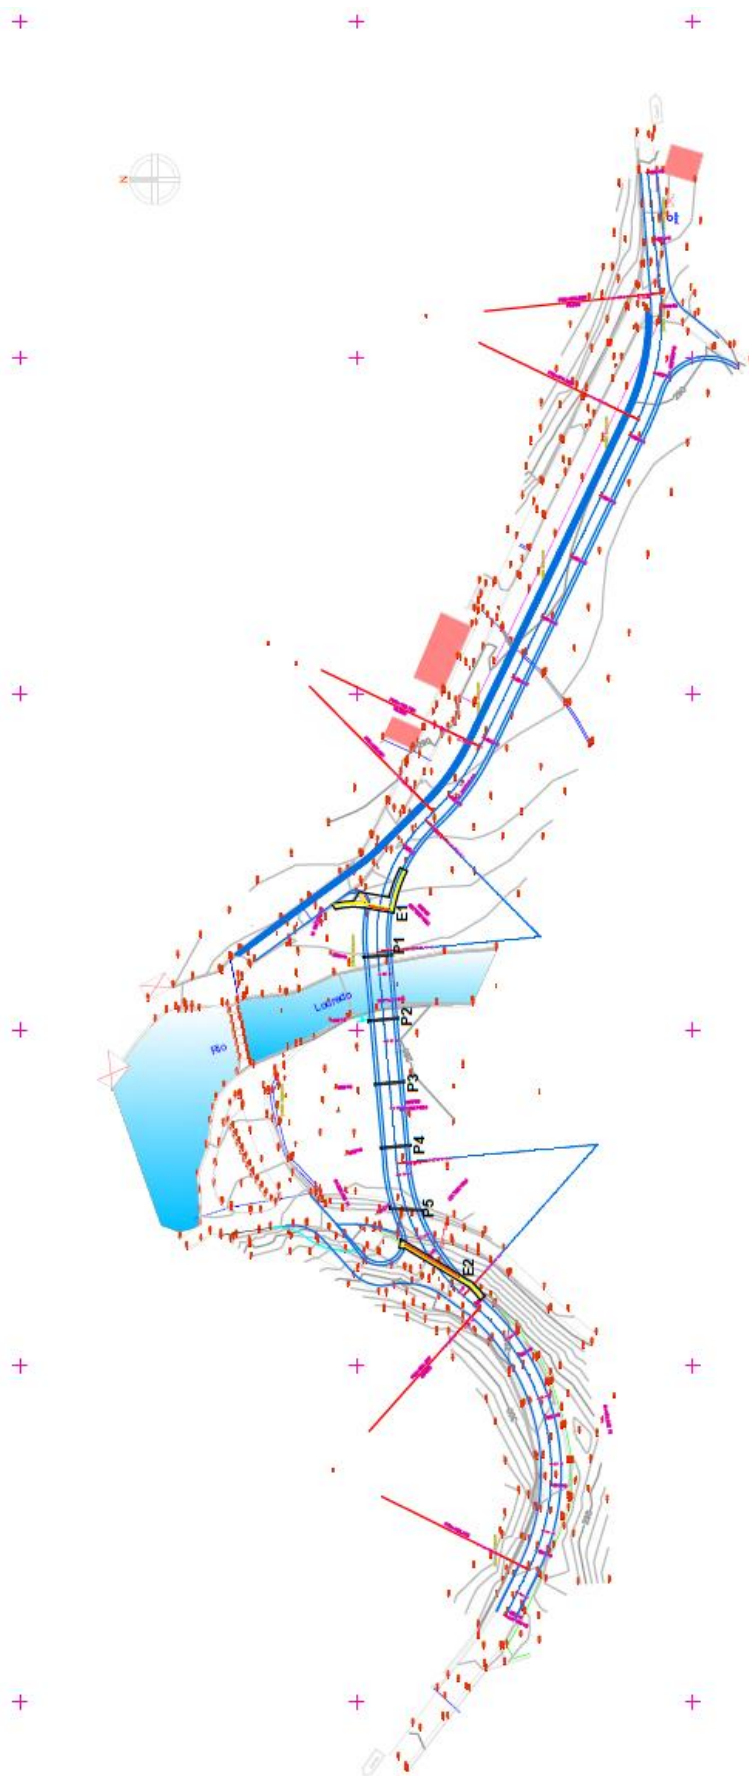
Planta de fundações da ponte sobre o rio Louredo. 1ª localização aconselhada.
